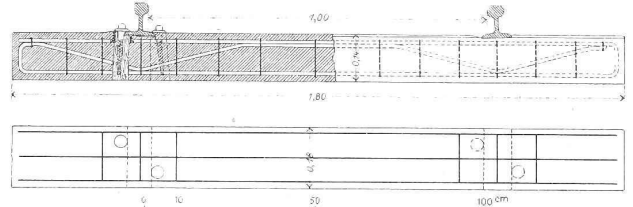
Längsschnitt und Draufsicht der Schwelle. — Masstab 1 : 20.
